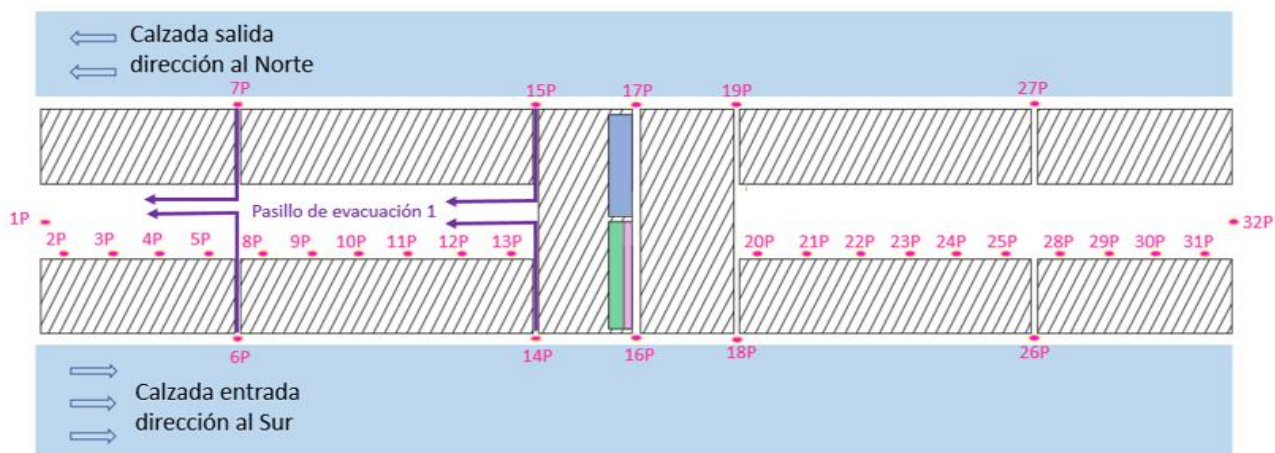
Distribución y numeración para las luminarias B65LED LVS2 (alumbrado de emergencia permanente)-vista planta
